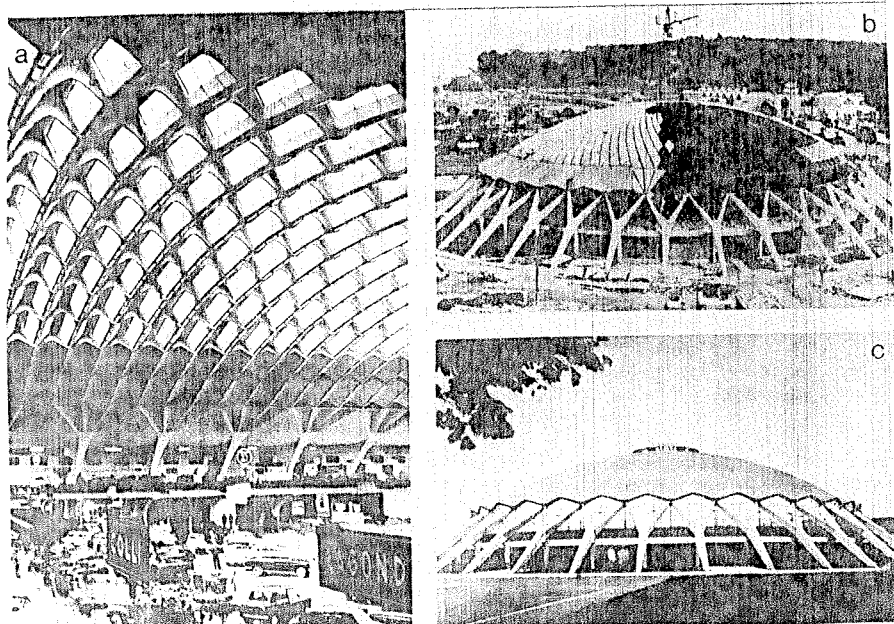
Duas das realizações de Pier Luigi Nervi com o ferro-cimento, no campo da construção civil, onde alcançou a notoriedade:
